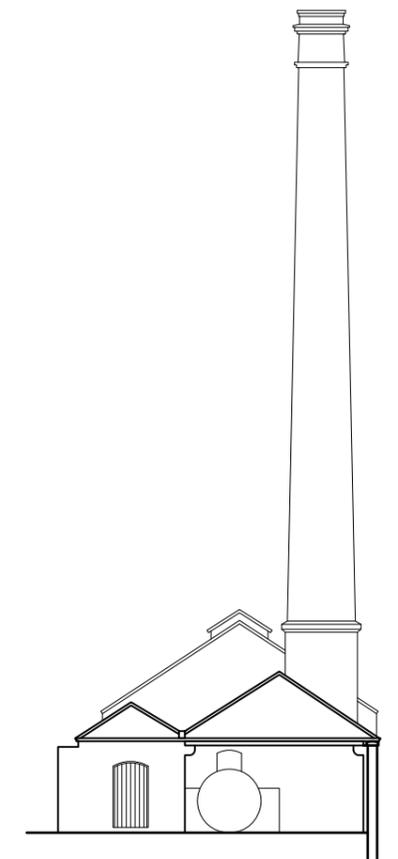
Ansicht 2 - Maschinenraum, Heizraum
